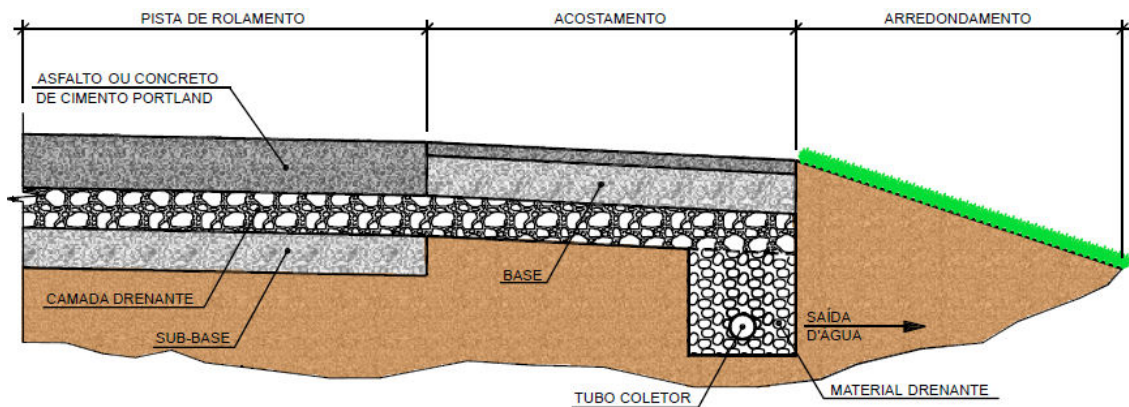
Ilustração da seção de pavimento mostrando posicionamento da camada de drenagem em pavimento com acostamento
